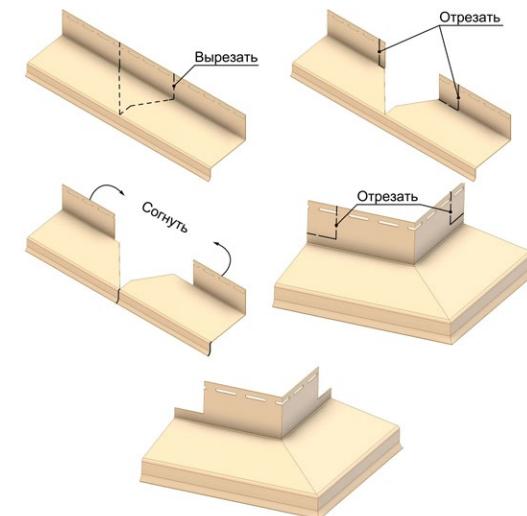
Изготовление внешнего углового элемента отлива Döcke.
